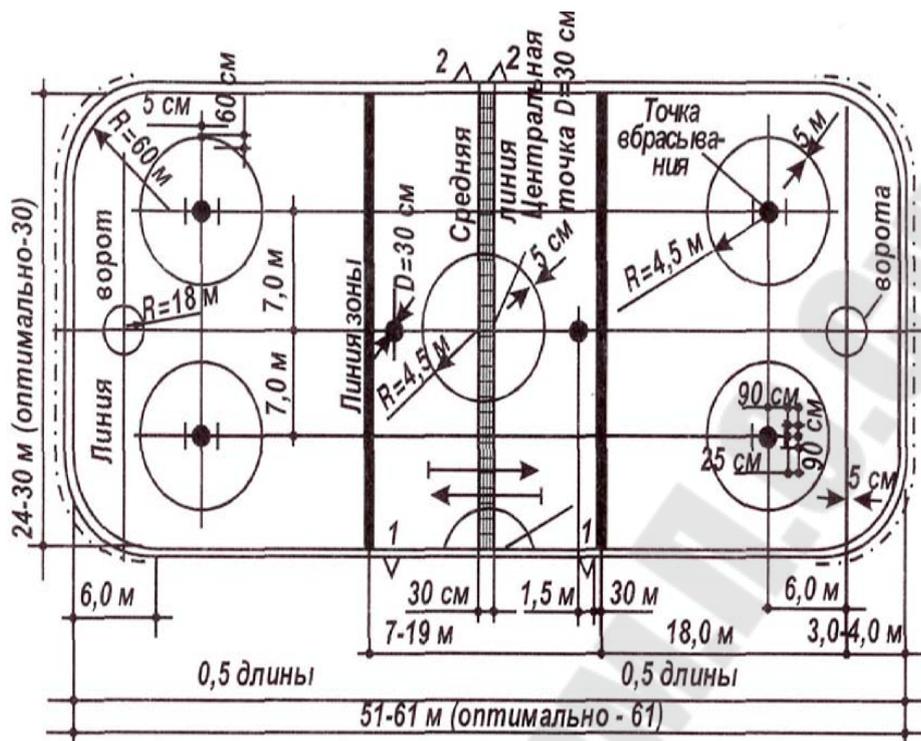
План и разметка площадки для хоккея с шайбой
